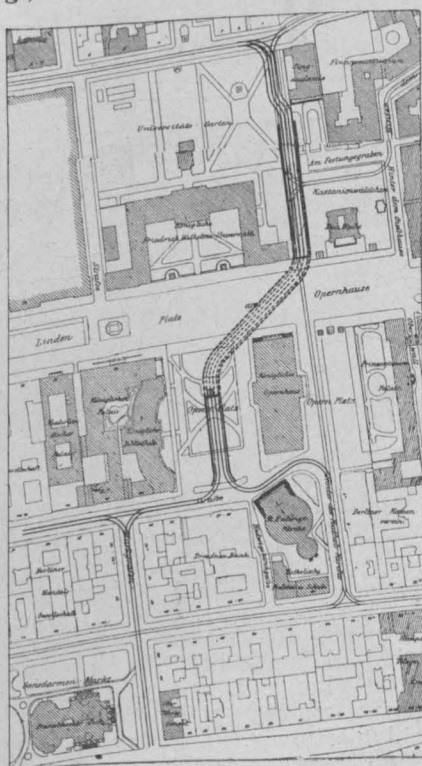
und 2. Vorentwürfe mit einfachem Tunnel. Lageplan rd. 1:6000.
